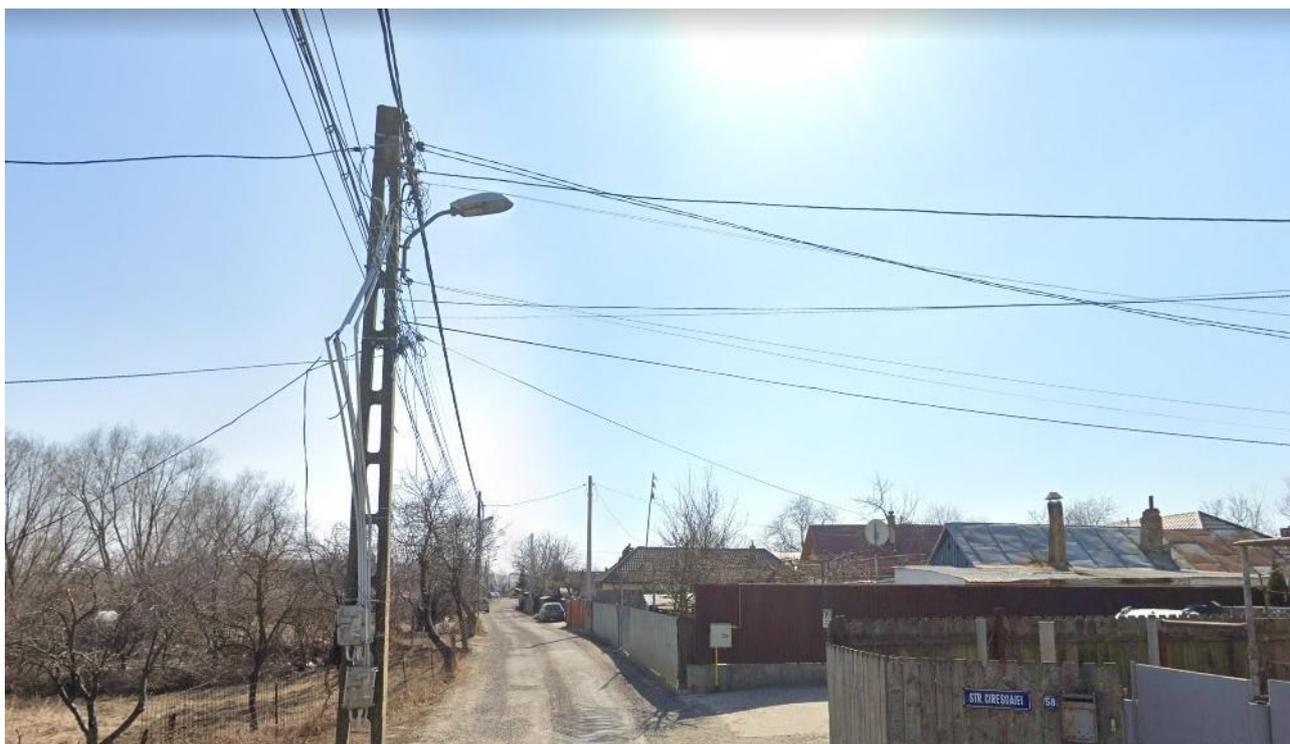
Amplasament existent Strada Ciresoaia Tr. 1
